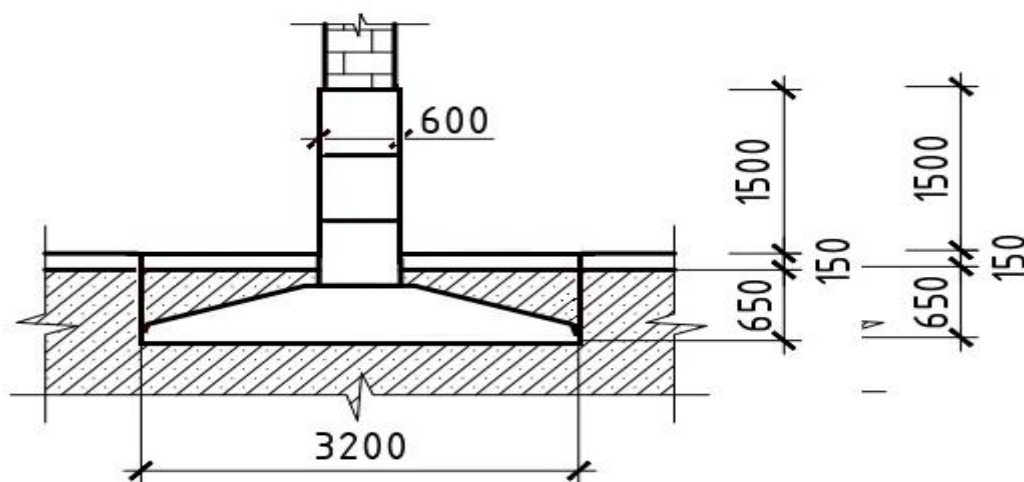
Схема фундаментної опори під внутрішню стіну
